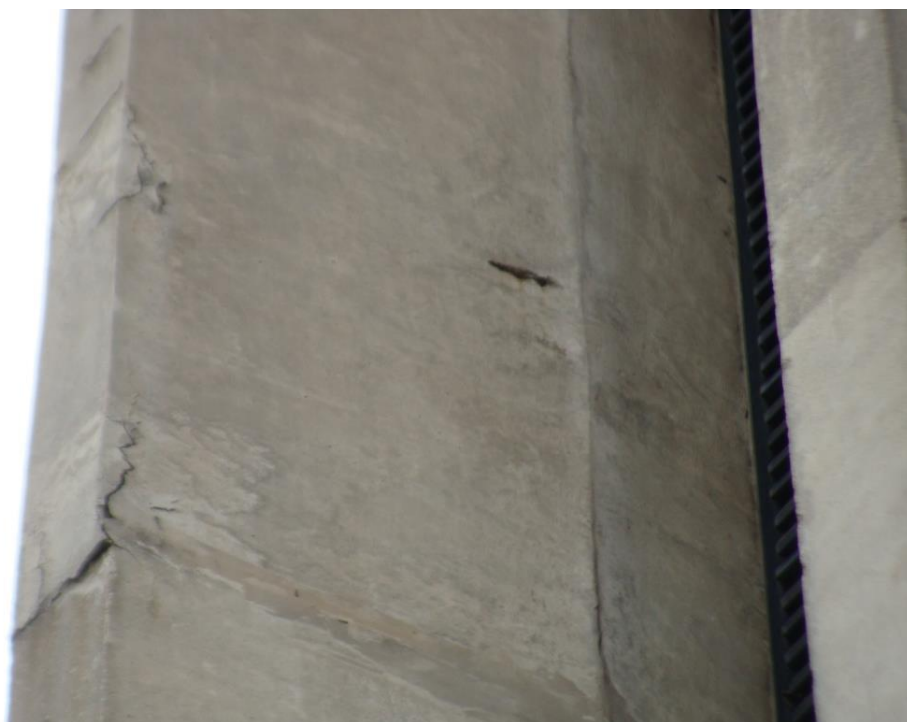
Armadura exposta pilar P11 (2º pavimento) (02/03/2021)
